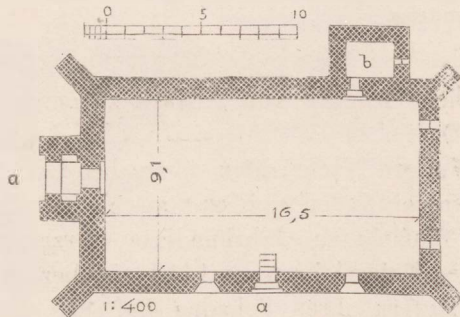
Gubin. Grundriss der Kirche.
